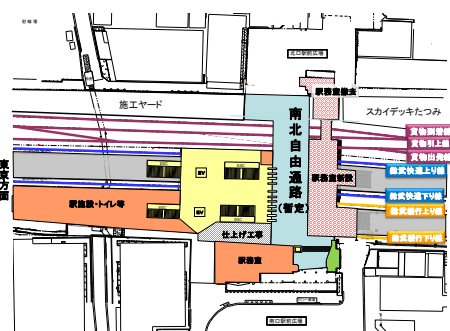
新小岩駅南北自由通路暫定使用開始(平面図)
